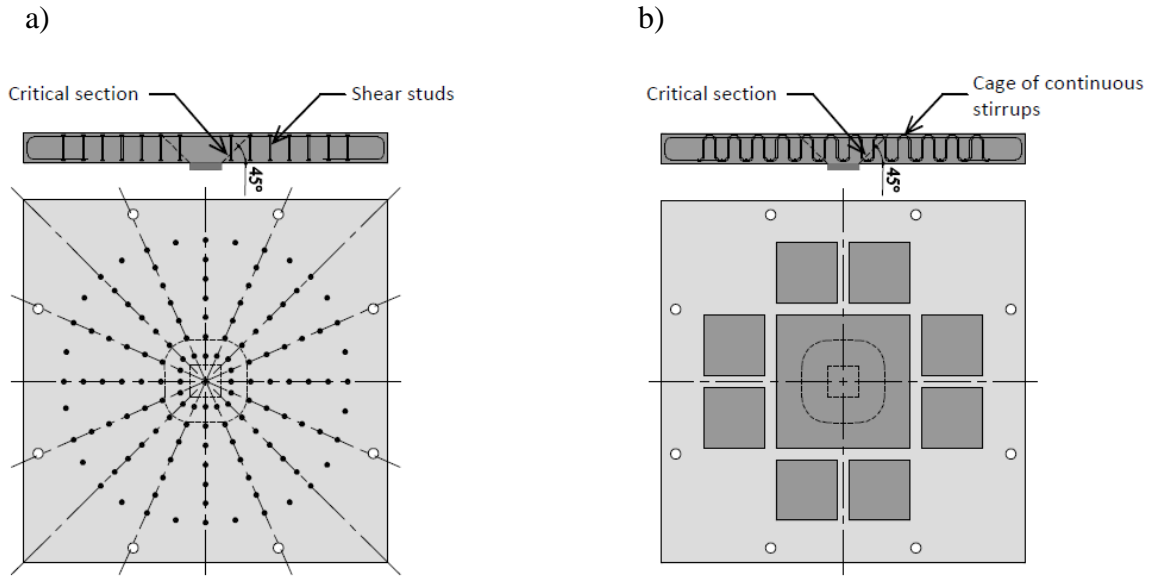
Definição da secção crítica e traçado do reforço transversal: (a) pinos transversais e (b) estribos contínuos [33]
